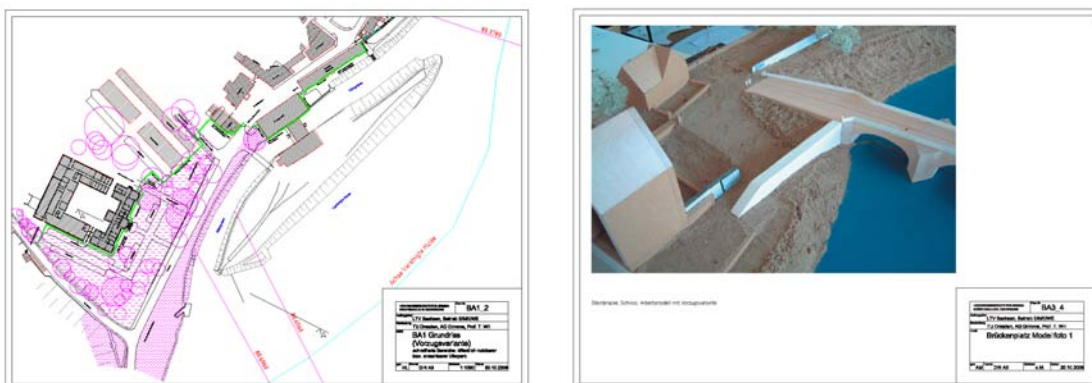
Beispiele für städtebauliche Lösungsansätze: BA 1 – Grundriss der Vorzugsvariante (links), BA 3 – Brückenplatz Modellfoto (rechts)
